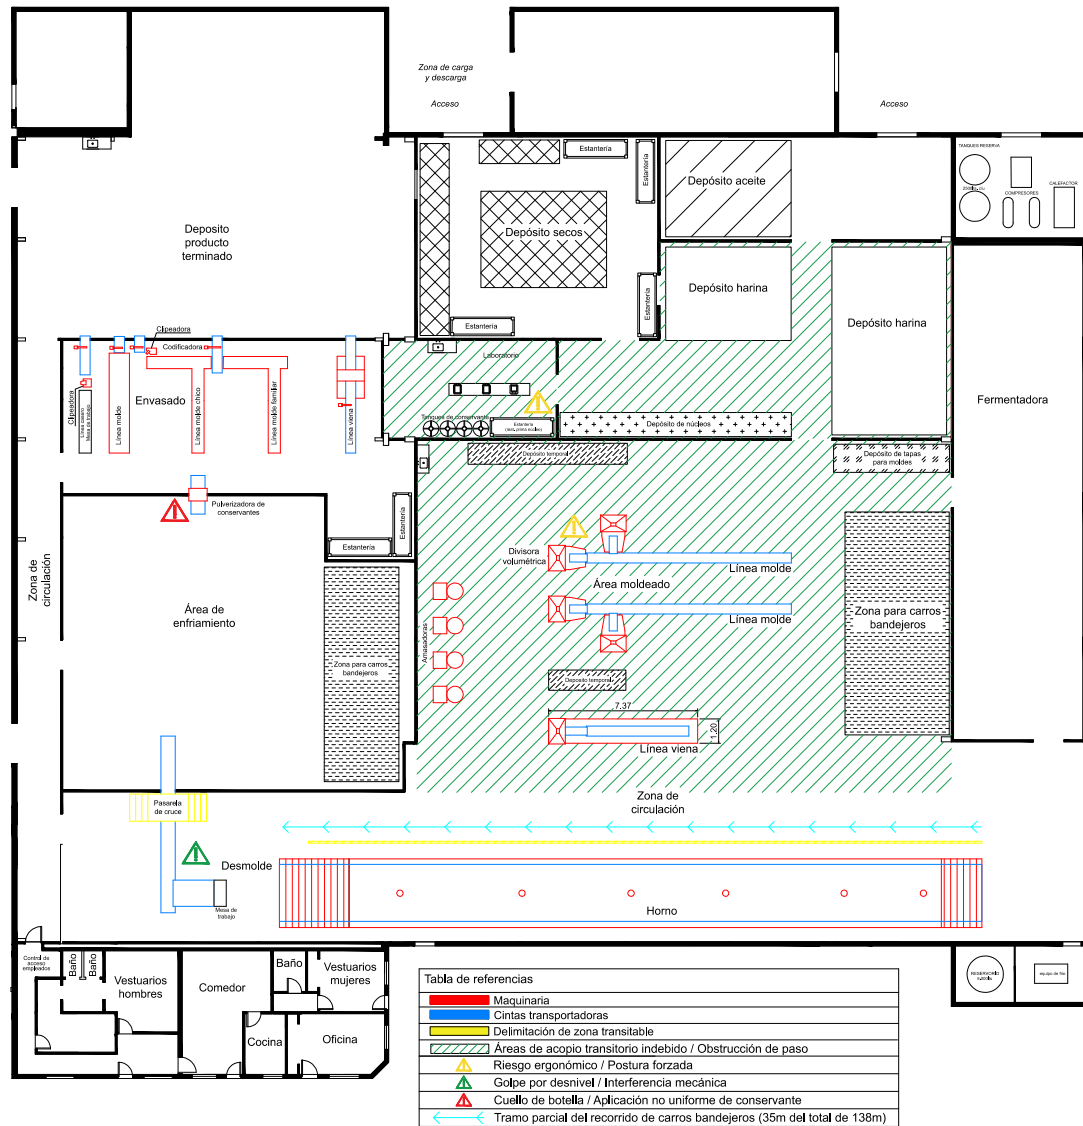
Distribución en planta original y localización de las situaciones críticas encontradas
